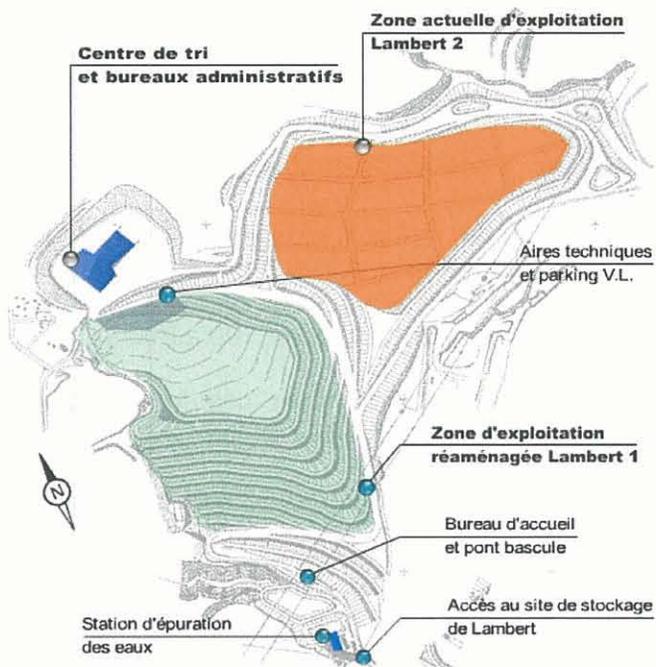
Plan des installations du centre de Lambert (SITASUD) (www.csd Lambert.com)
